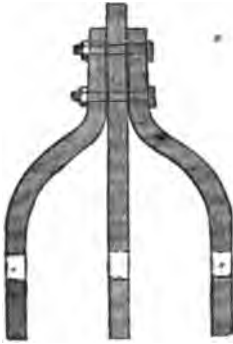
Appendici attaccate al conduttore del parafulmine.
